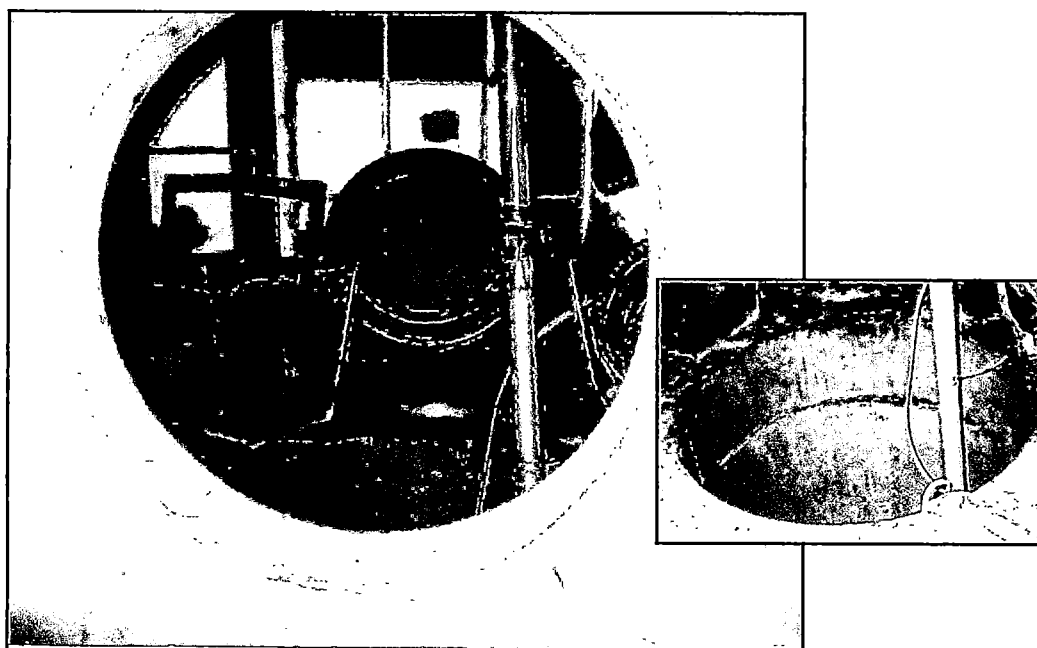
Ducto para el acceso de los trabajadores par a seguir la excavación.
